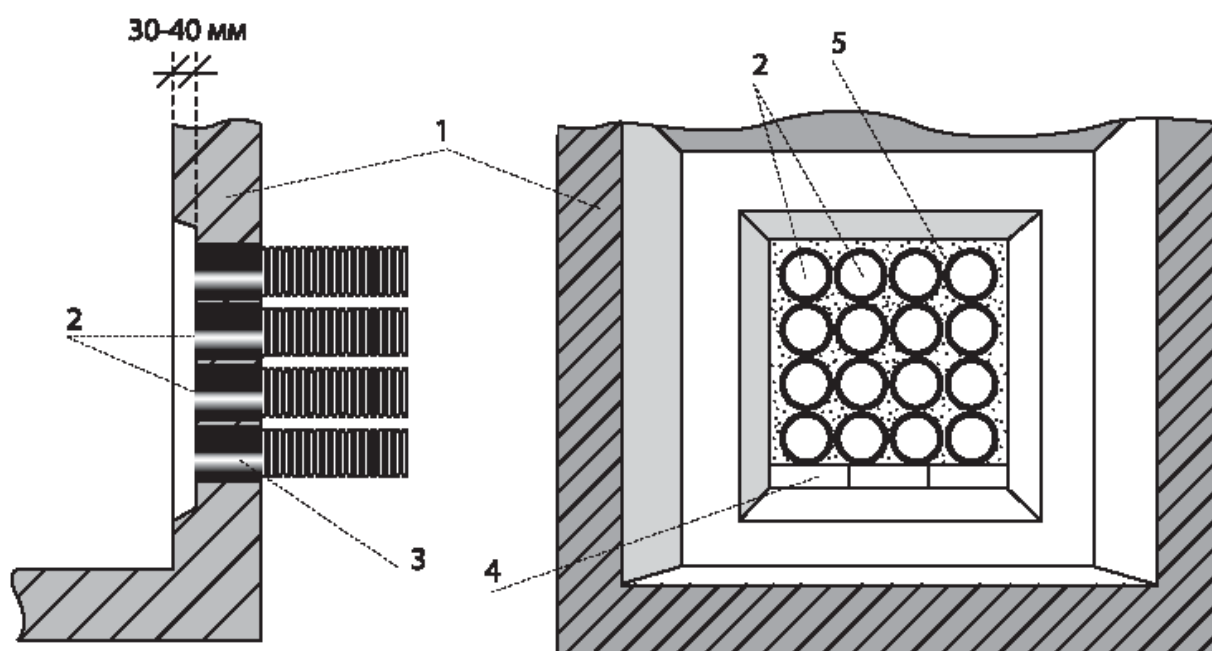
Традиционный ввод трубопроводов в кирпичные и железобетонные колодцы:
